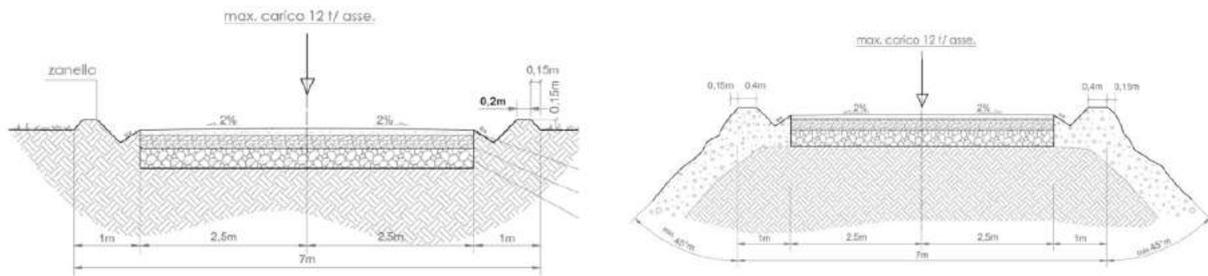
Sezione stradale tipo in piano (a sinistra) e sezione stradale tipo in rilevato (a destra)
